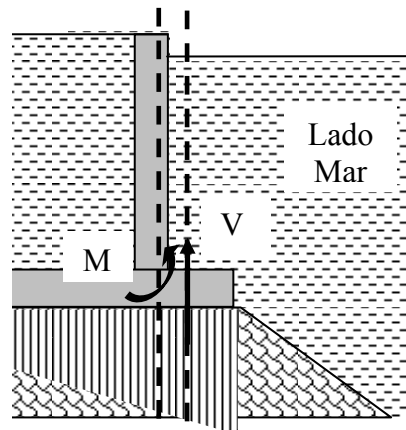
Secciones de referencia para el cálculo de esfuerzos en el voladizo
